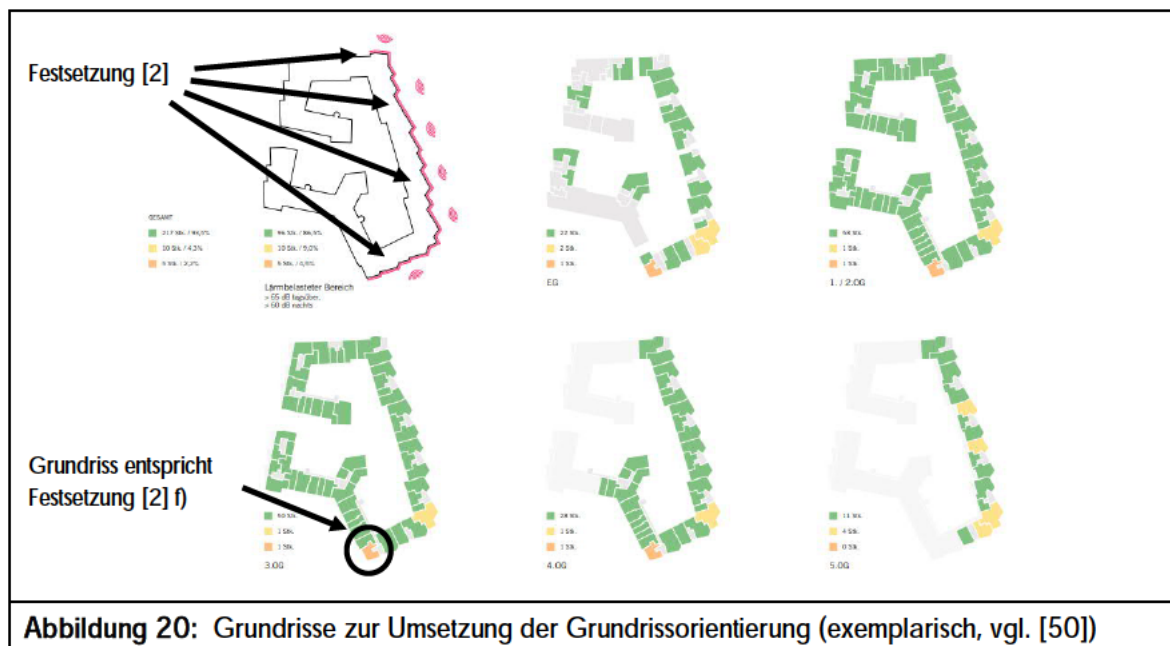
Grundrisse zur Umsetzung der Grundrissorientierung (exemplarisch, vgl. [50])
